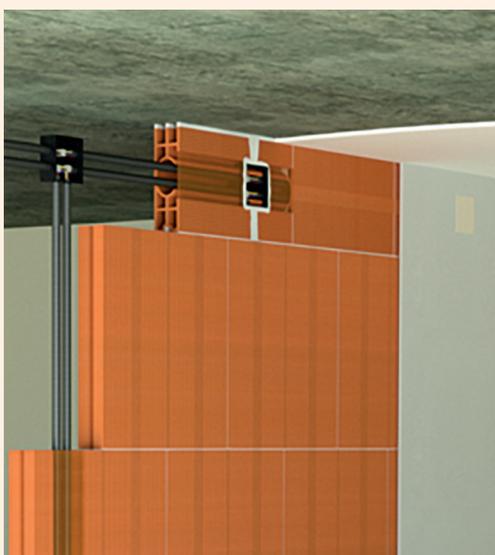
MURALIT Sin Rozas. Colocación de las instalaciones en una obra SIN falso techo
